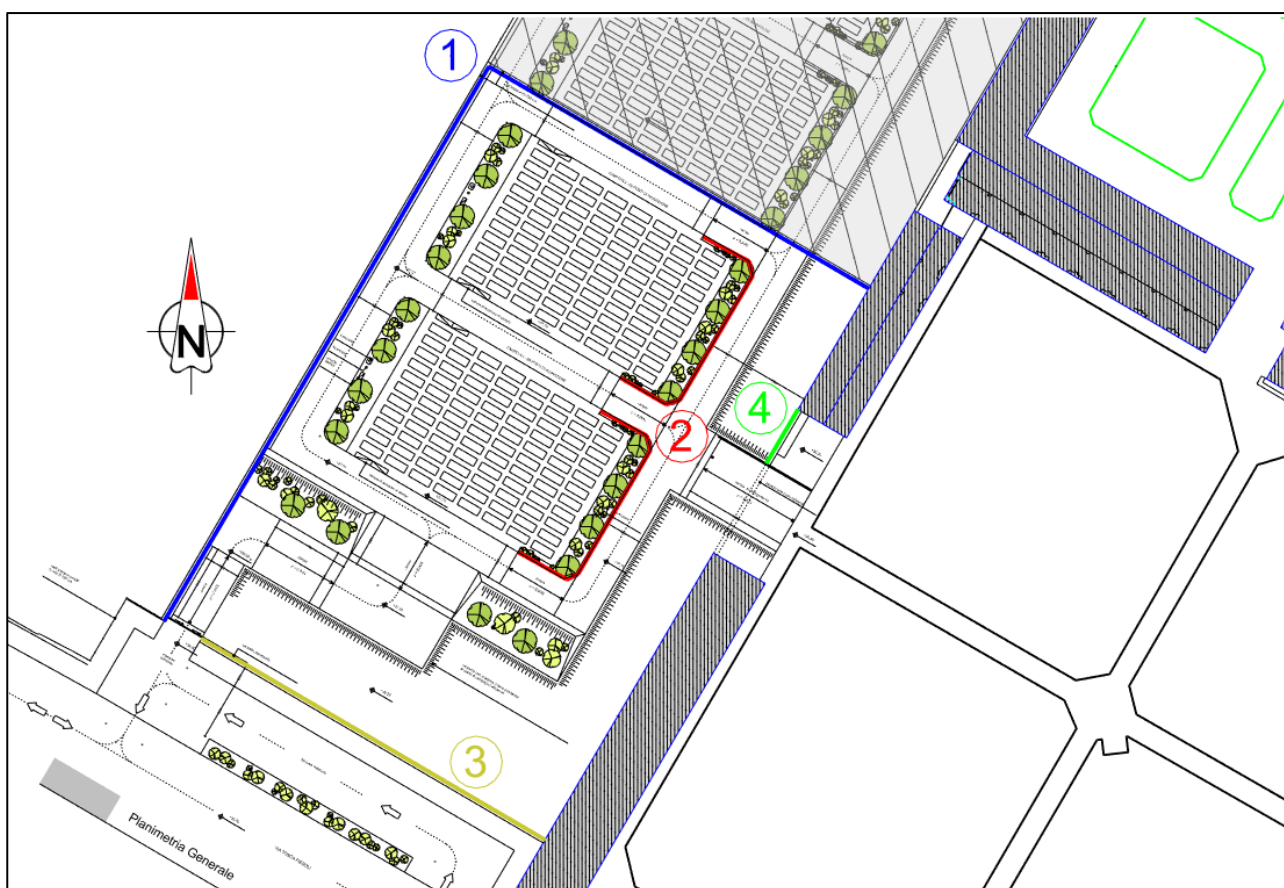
Planimetria di riferimento con individuazione tipologia opere strutturali
